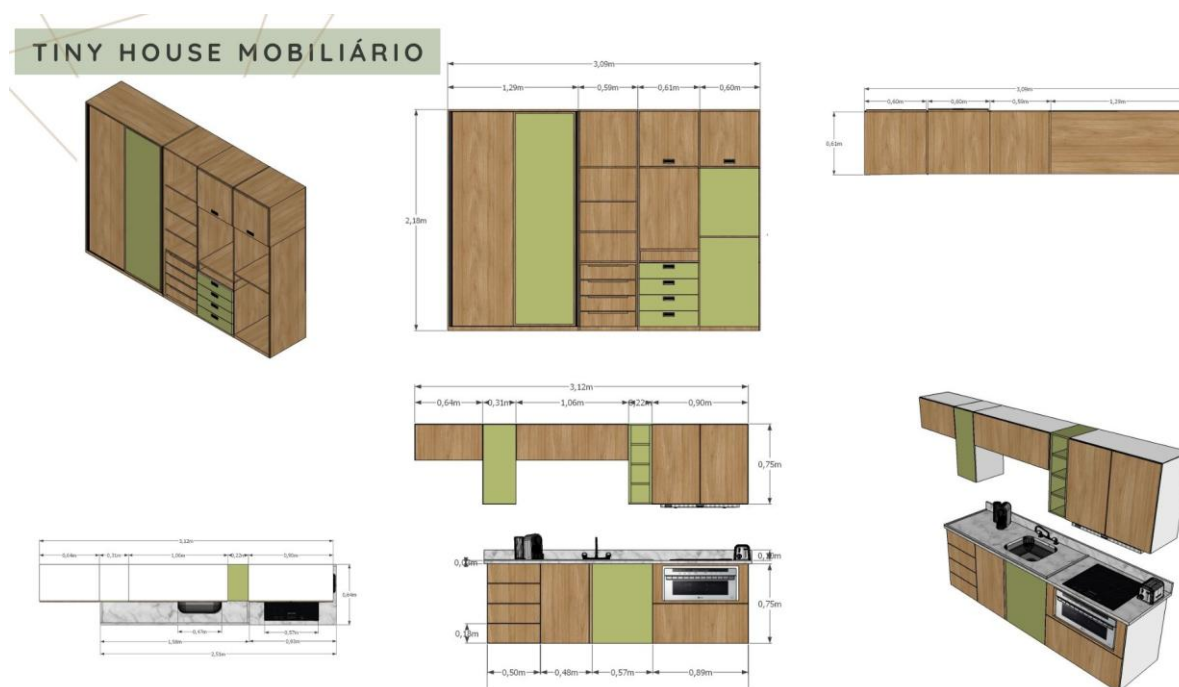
Projeções e medidas dos móveis planejados da Tiny House.
